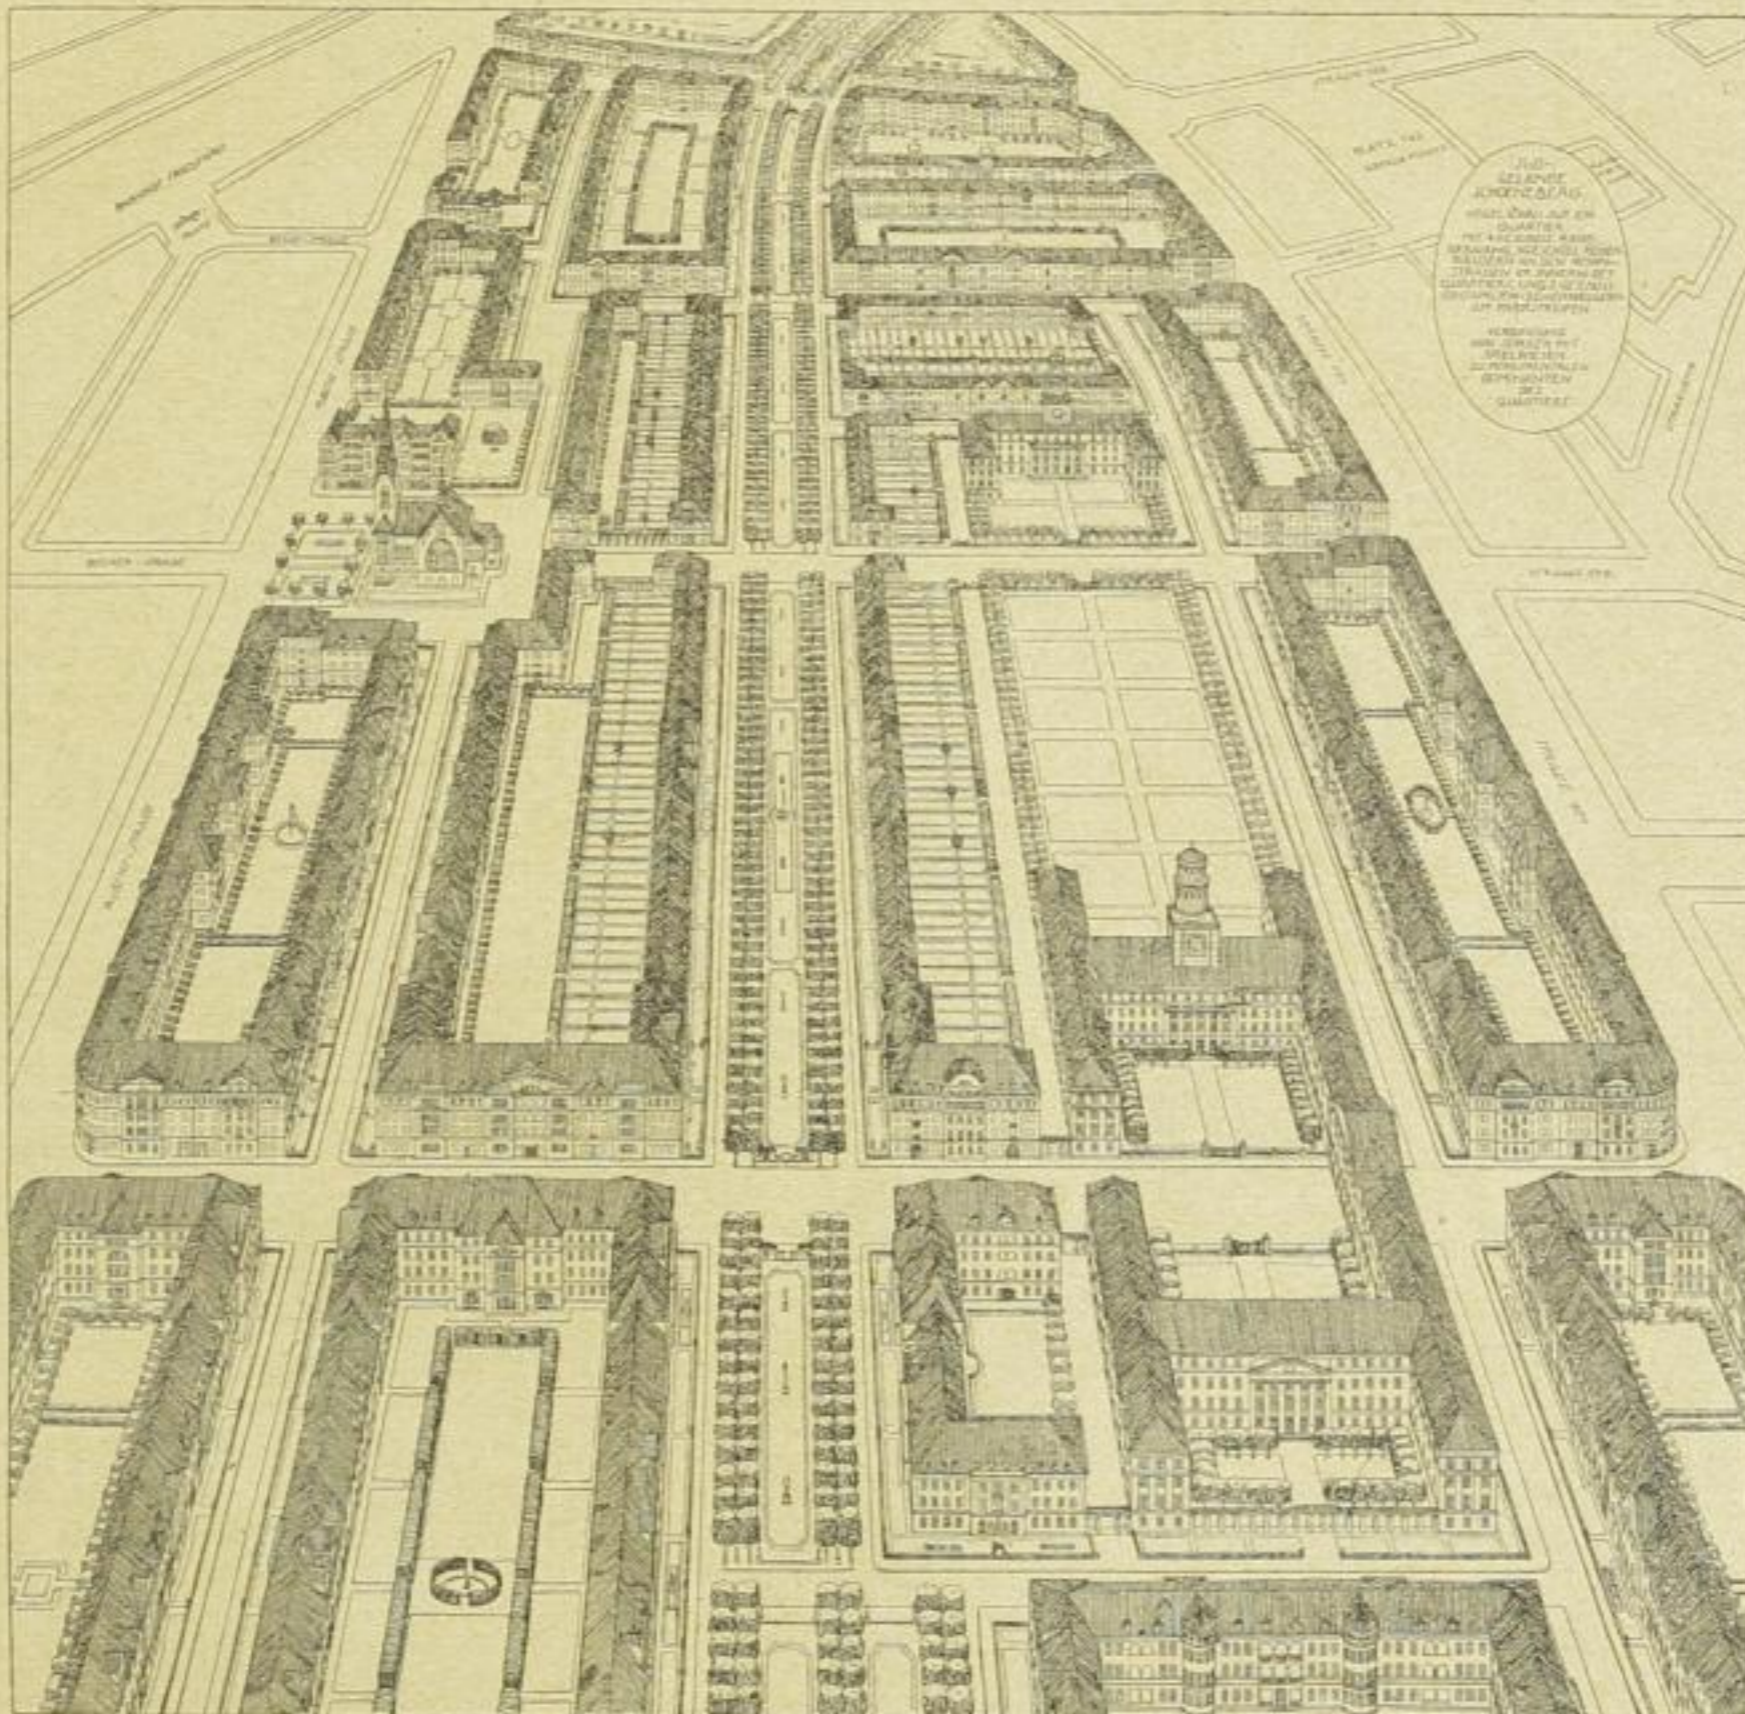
Wohnviertel aus dem Bebauungsplan für das Südgelände in Berlin-Schöneberg.
